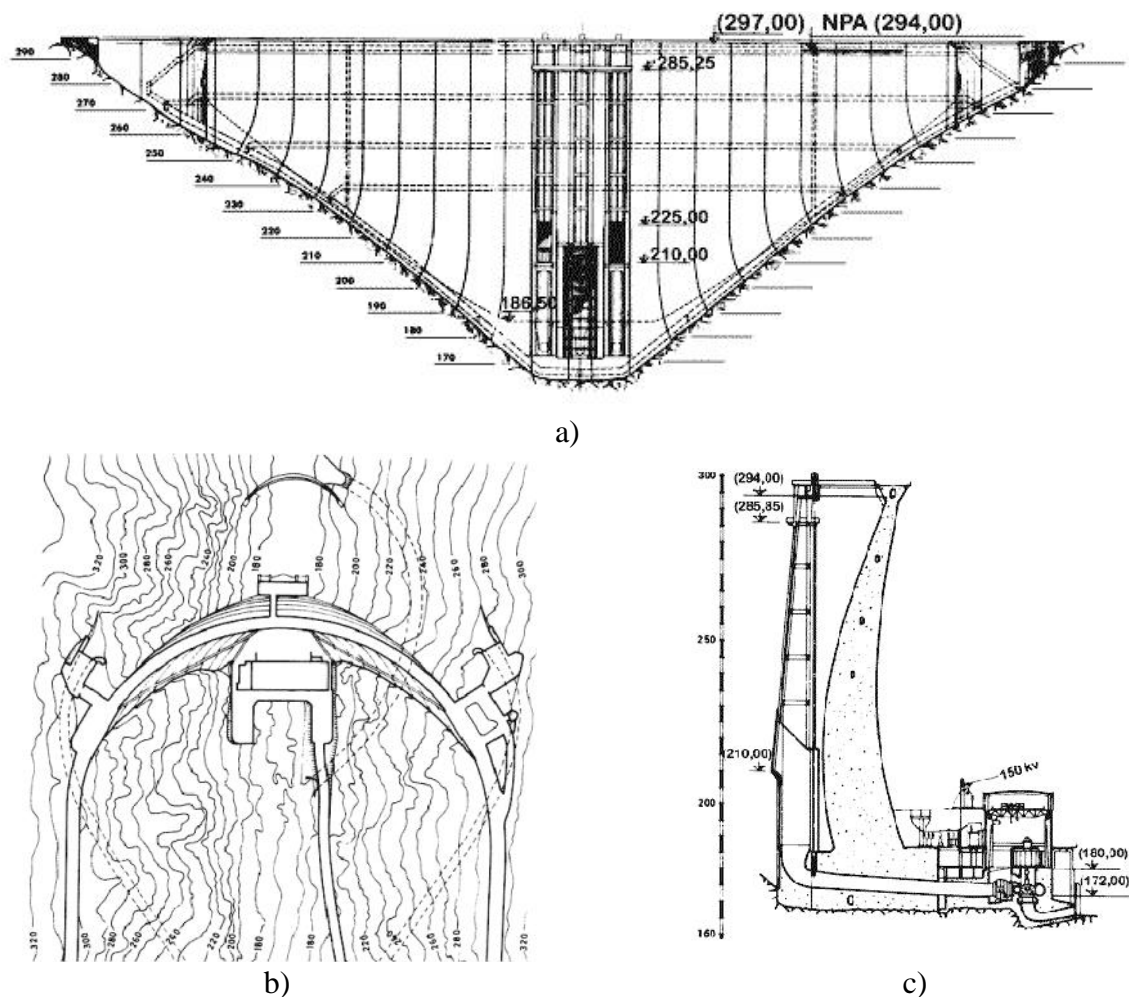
Barragem do Cabril: a) Vista de montante; b) Planta; c) Perfil transversal (INAG, s.d.).
